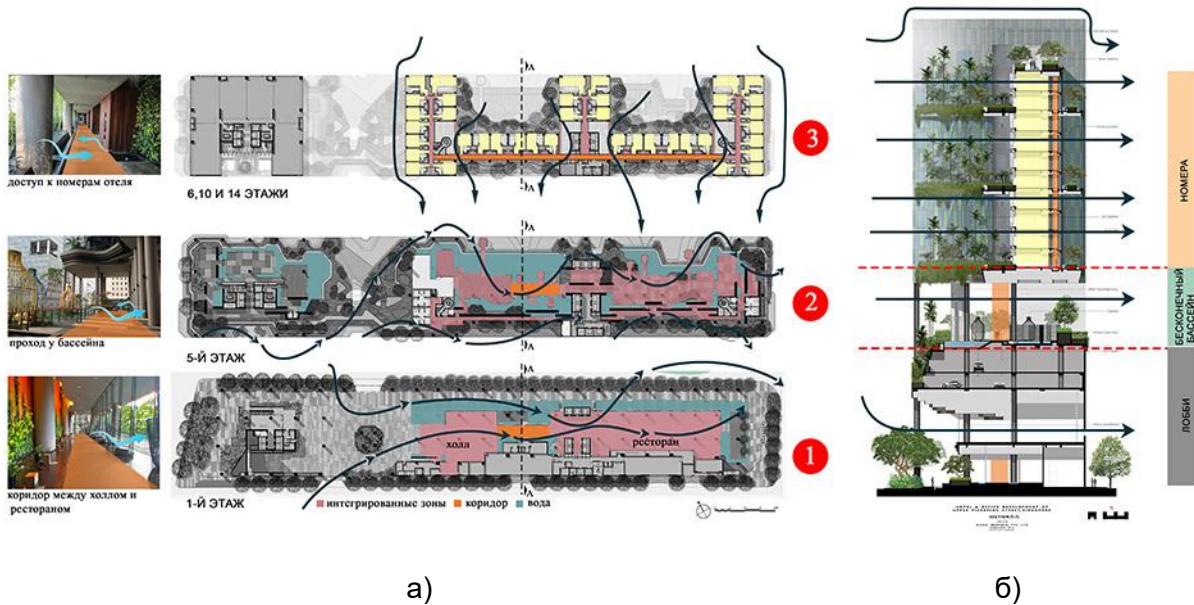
Схемы движения воздушных потоков на этажах отеля: а) план этажа; б) разрез А-А
